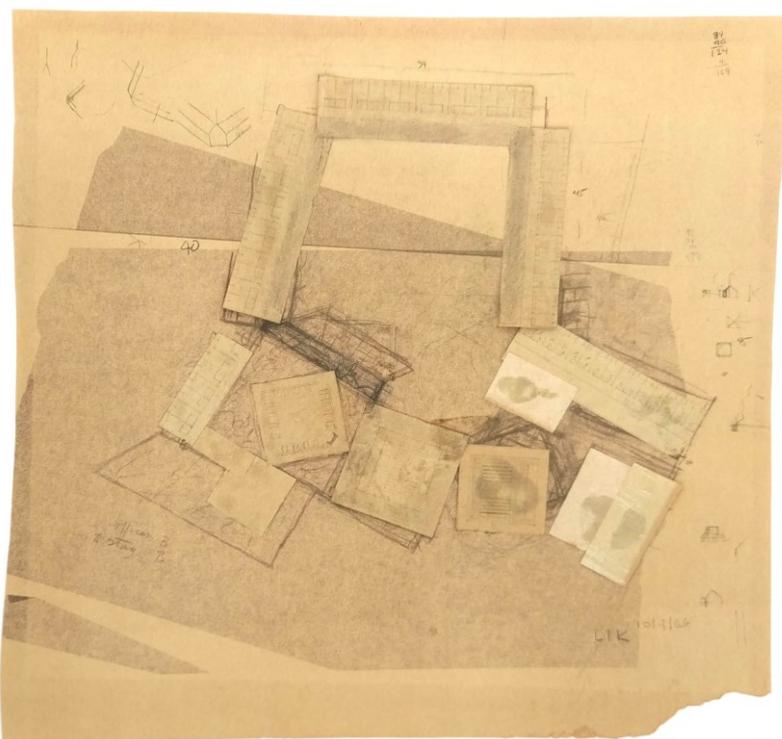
Casa-mãe Dominicana. Planta baixa feita por colagem. Louis Kahn, outubro, 1966.
